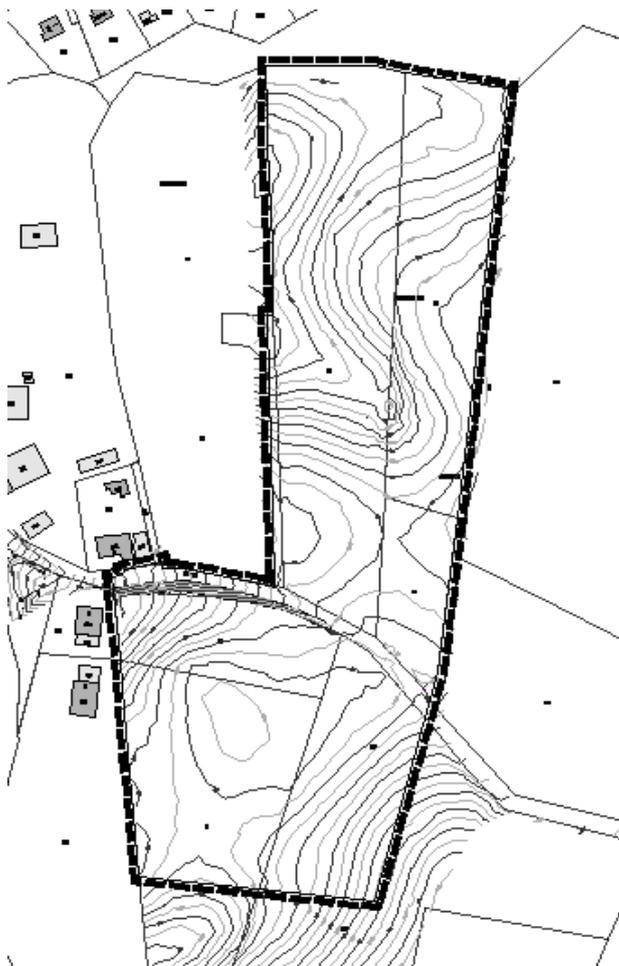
Lageplan mit Geltungsbereich „Haselweg, Alttann“, ohne Maßstab
